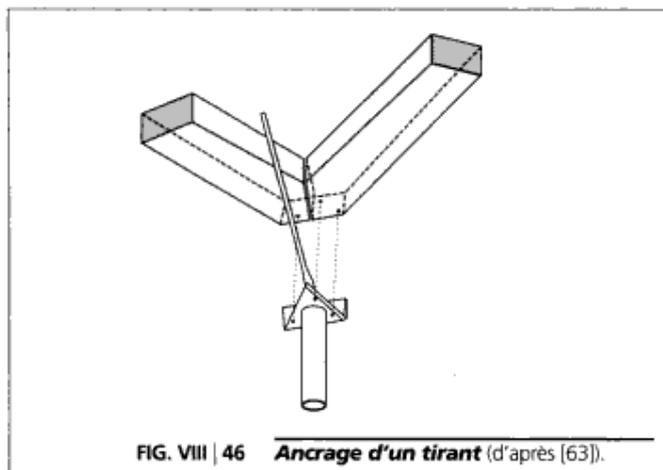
Ancrage d'un tirant (d'après [63]).
